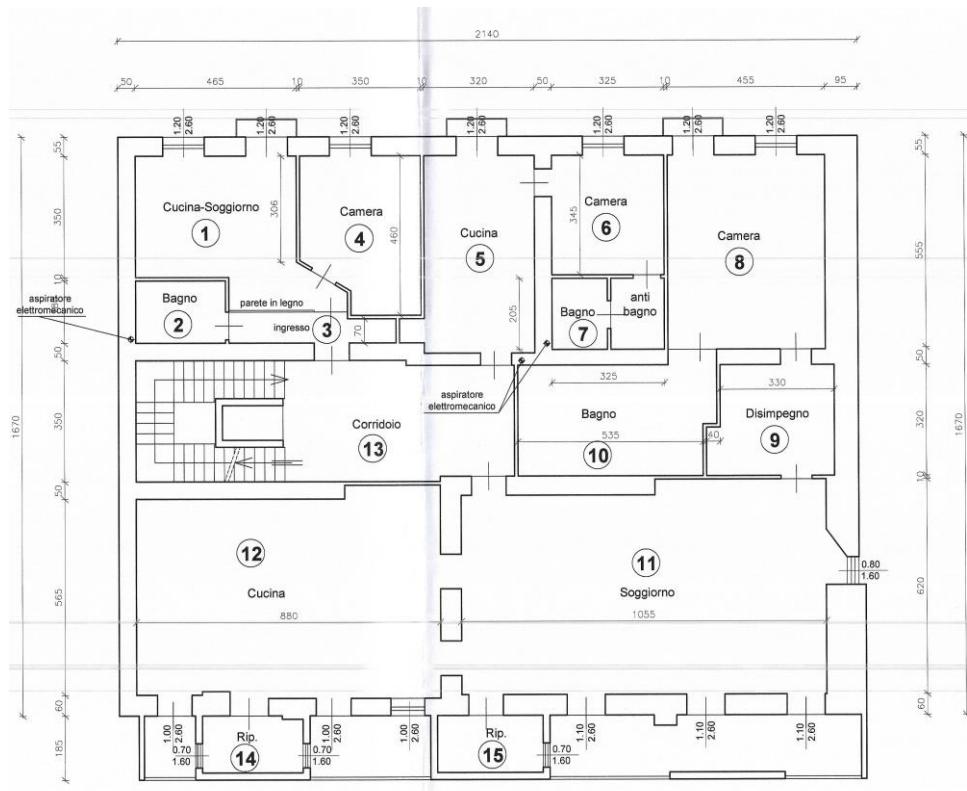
Comparazione stato approvato – stato rilevato ([Allegato 12](#))
